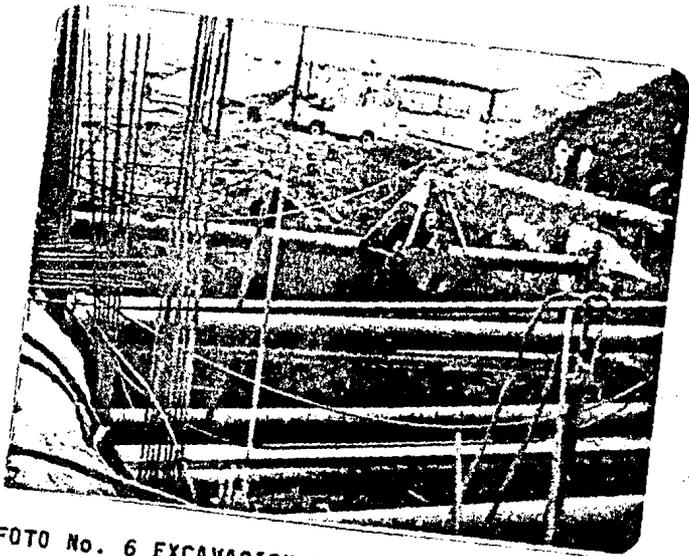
EXCAVACION Y COLOCACION DE TROQUELES
